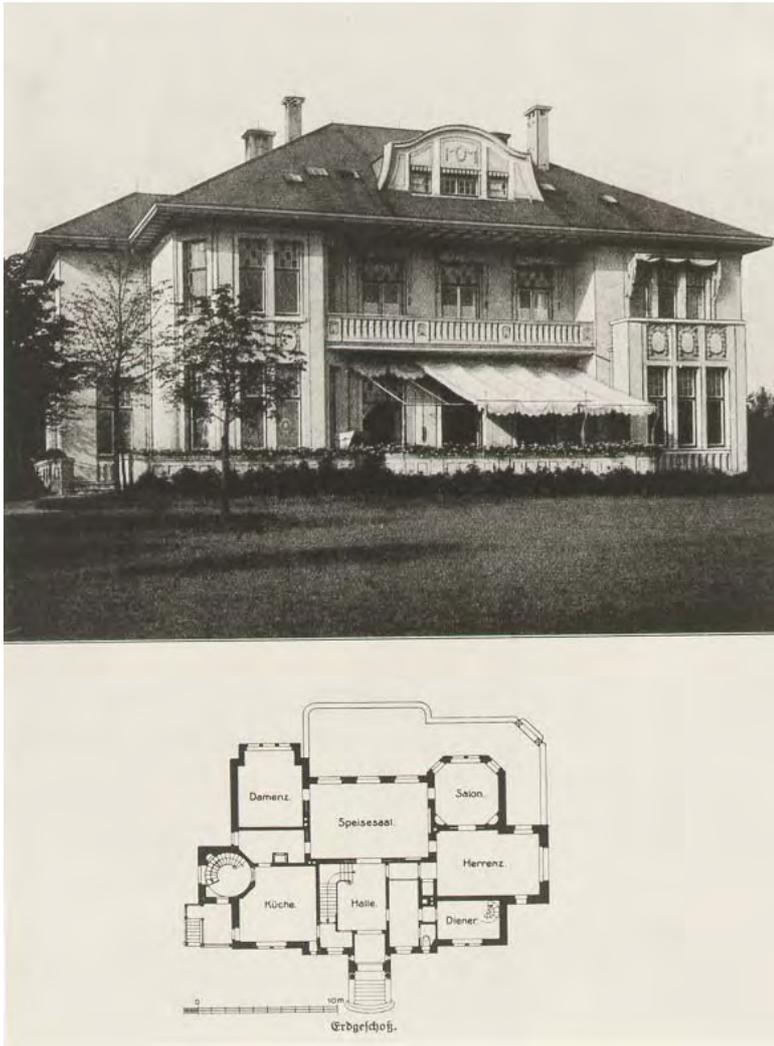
Gartenfassade der Villa und Erdgeschoß-Grundriß
